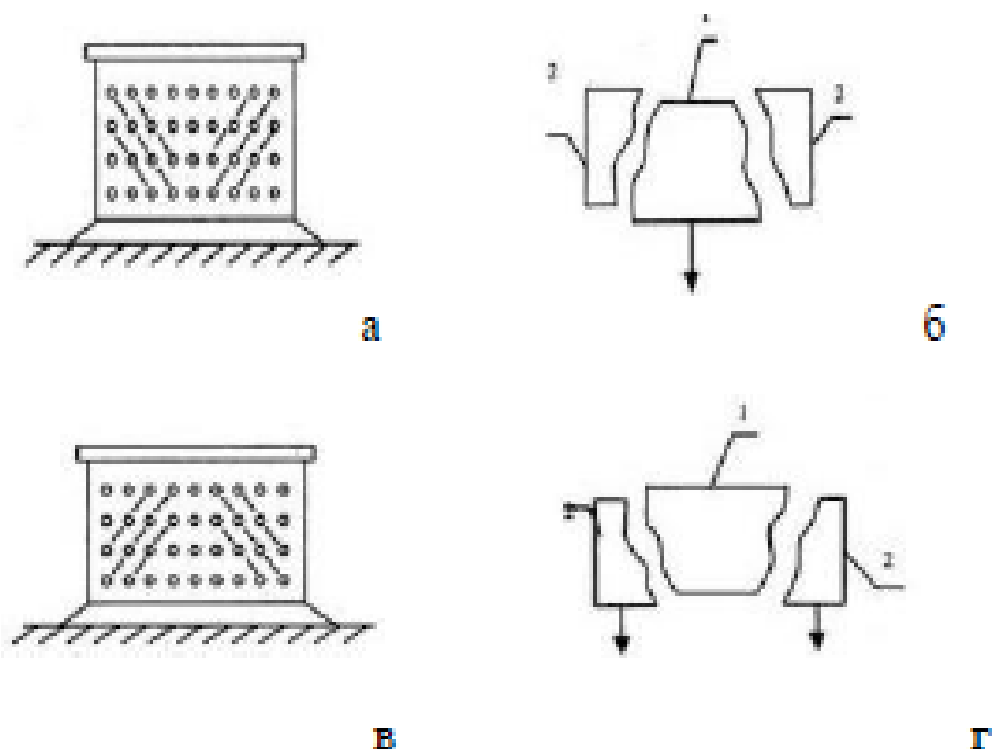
Формализованные схемы возможных осадок кирпичных зданий и линейно-протяженных сооружений: а- при преимущественных осадках краев здания; в- при осадках средней части здания; би г- упрощенные схемы перемещений; 1 - середина здания. 2 - края здания
